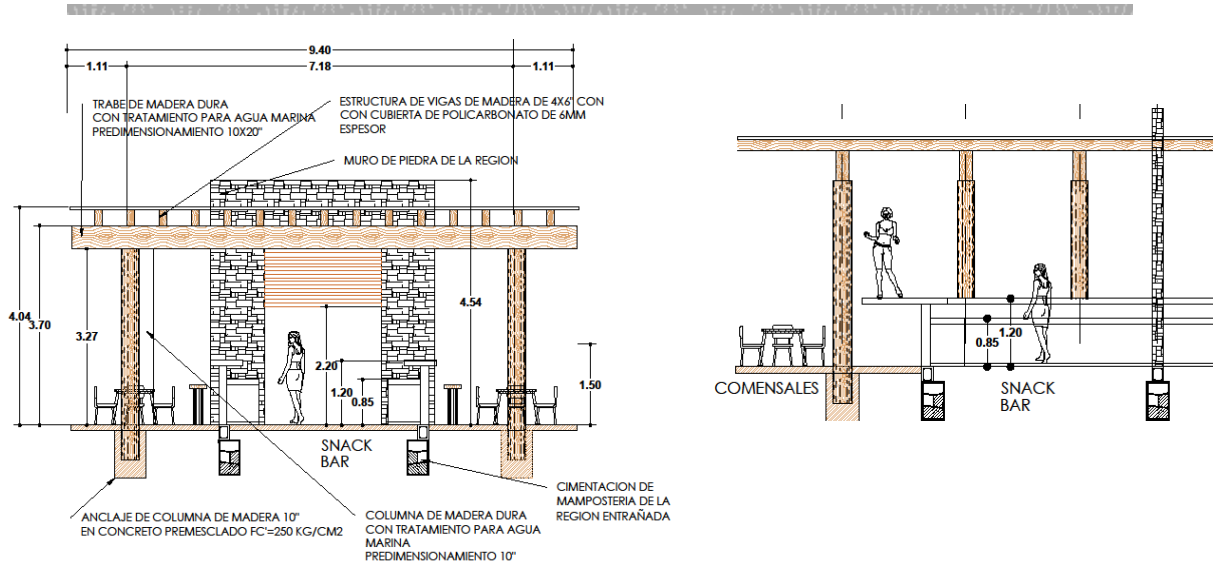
Vistas del bar y área de comensales que se proyecta como parte de las modificaciones del Club de Playa, donde se detalla las características estructurales de la obra a desarrollarse. Fuente: Promovente.
